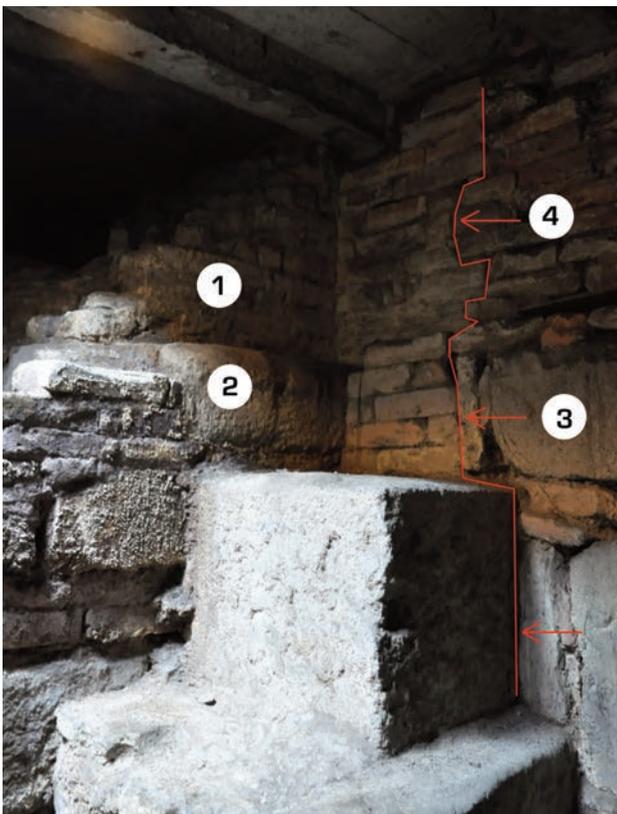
Santa Sofia: trincea di drenaggio: fondazione (2) con alzato in laterizi (1) del lato ovest del transetto al quale si appoggiano la fondazione (3) e l'alzato (4) del perimetrale della navata.
